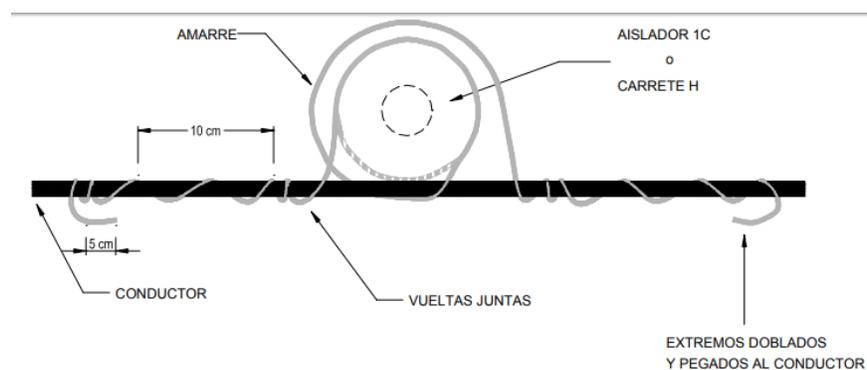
Amarre para conductor de baja tensión
